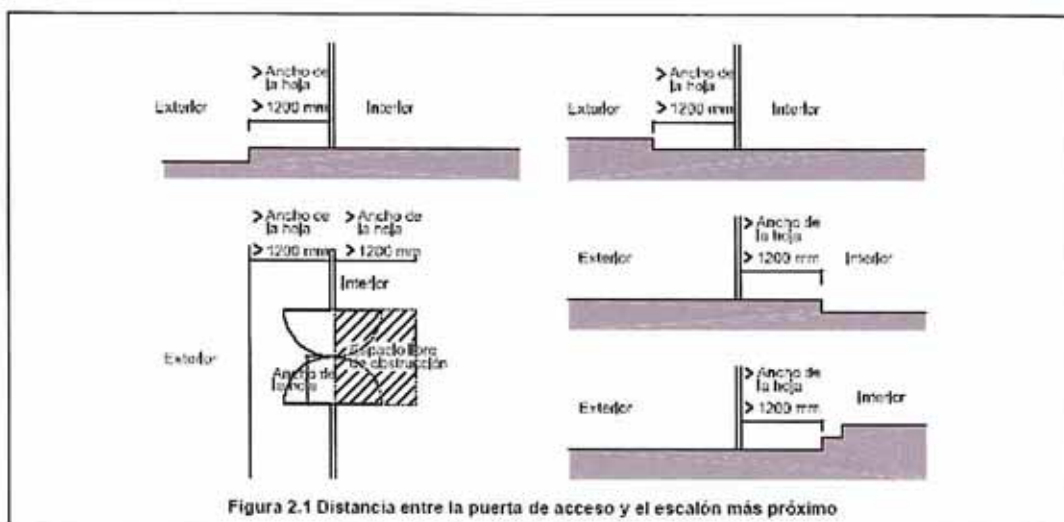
Distancia entre la puerta de acceso y el escalón más próximo
